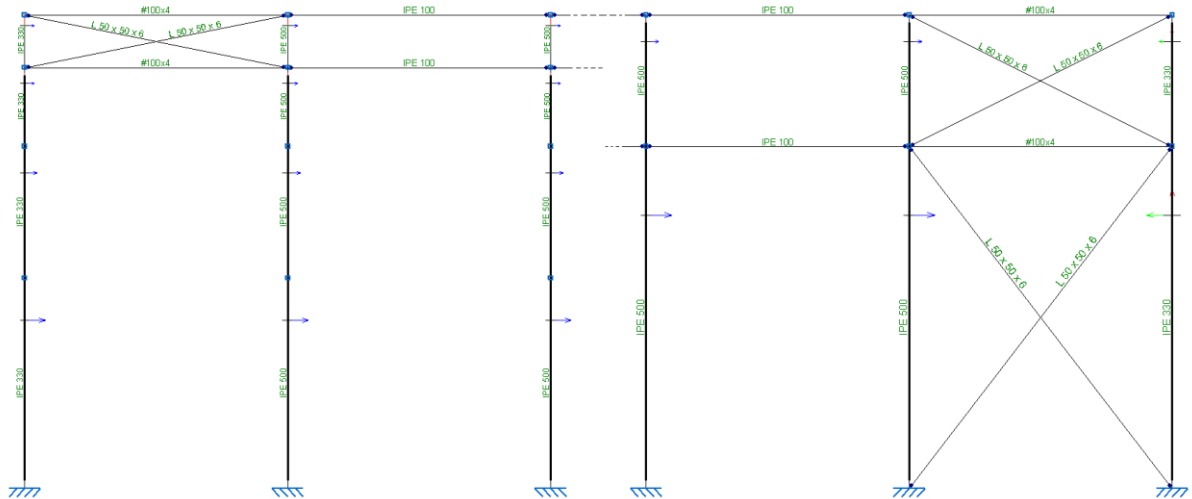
Detalle perfiles fachada lateral intermedia
